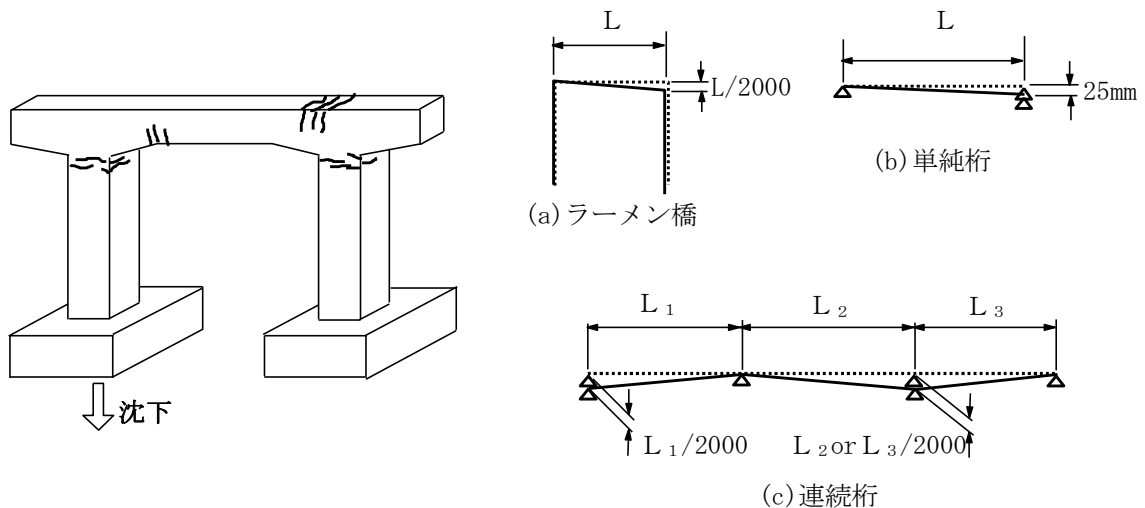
基礎の沈下によるひび割れ例と判定区分の目安
